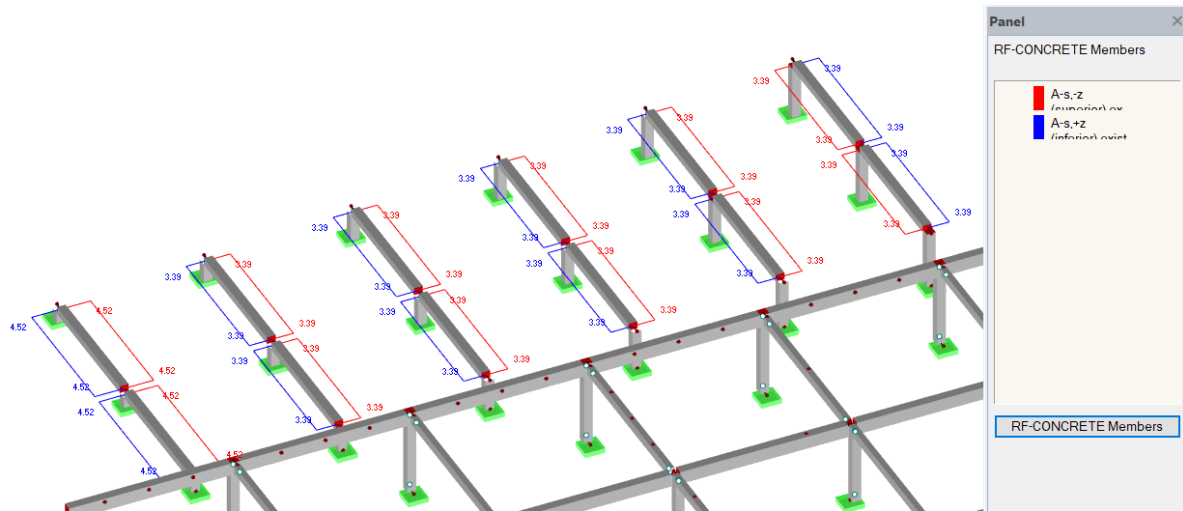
Cantidad de armadura existente en las vigas del vaso de la piscina.
